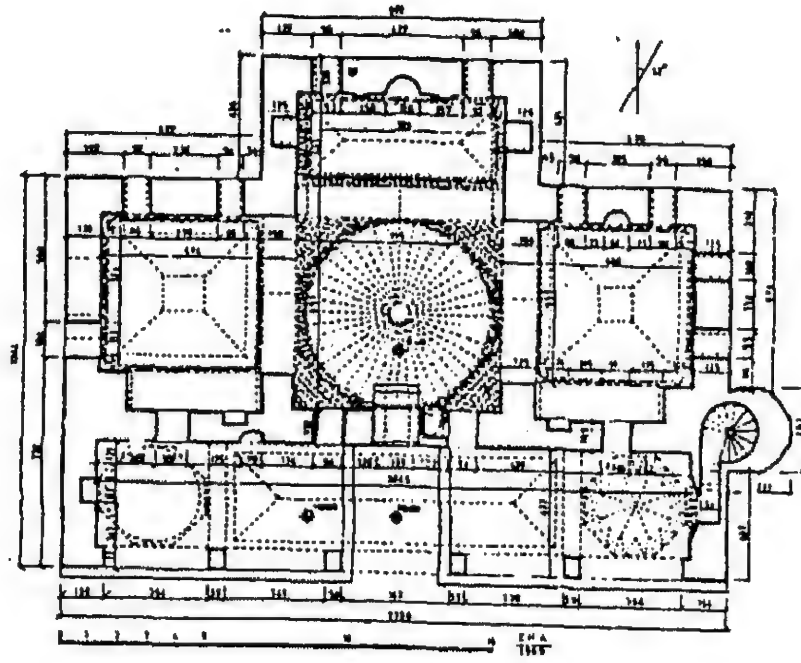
مسقط أفقي لمسجد البيلربي في أدرنة (عن : اصلان ابا)
